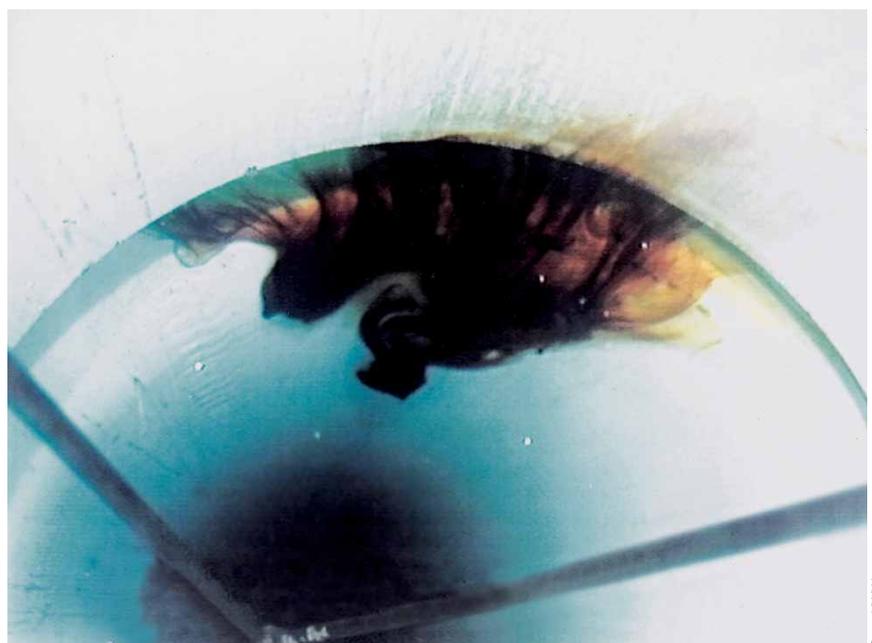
■ Undichte Gewindeverbindung; Eintritt von huminstoffhaltigem Wasser.
